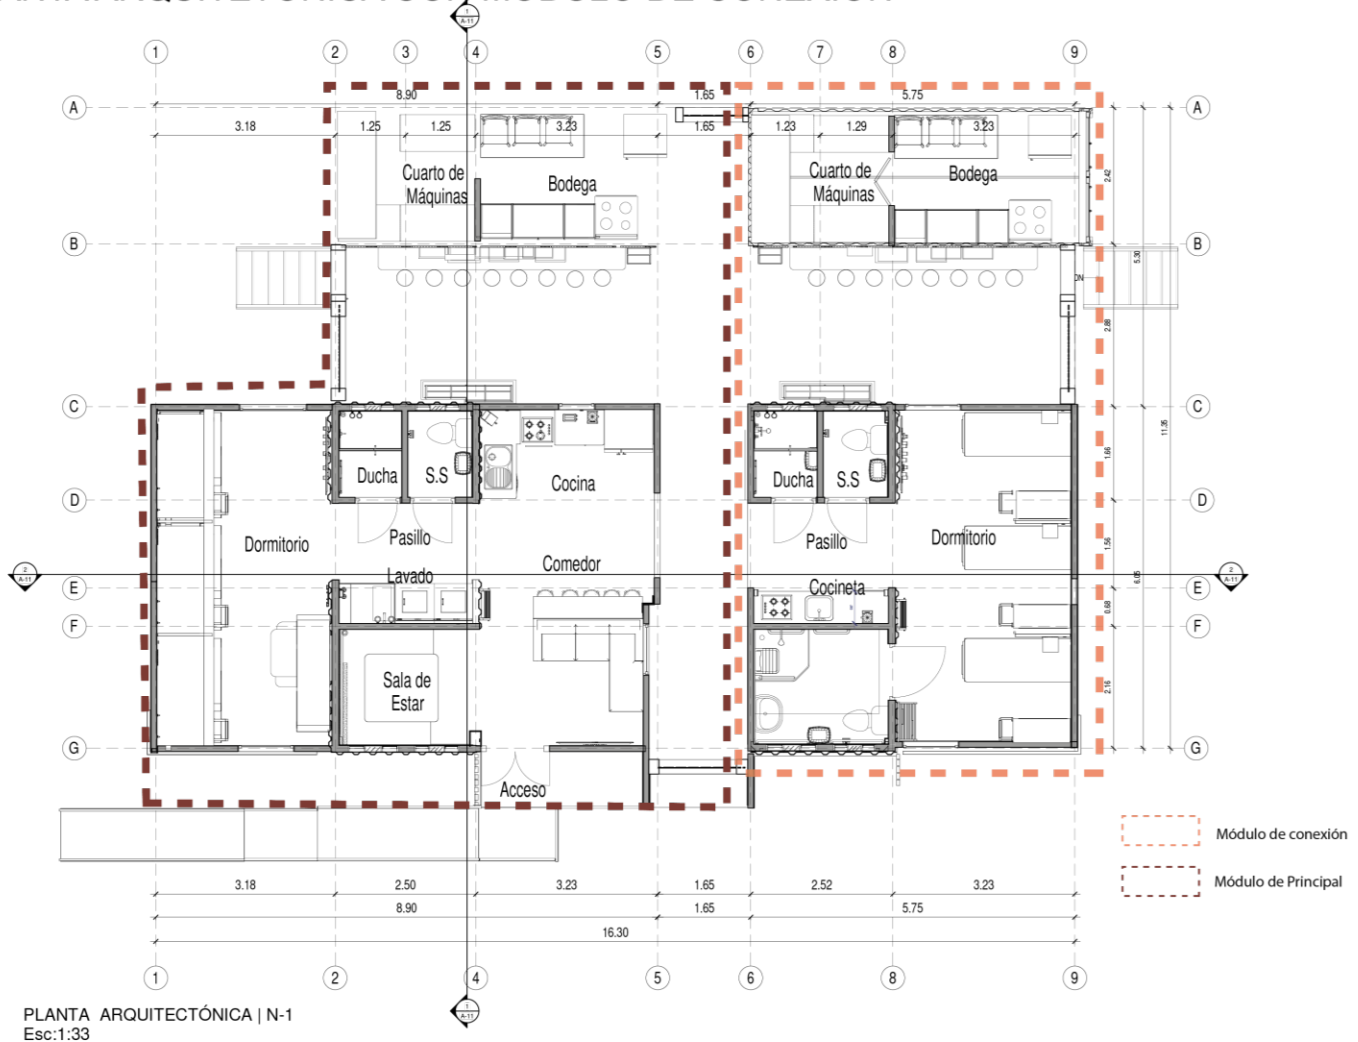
Planta Arquitectónica con módulo de conexión. Elaboración Propia
